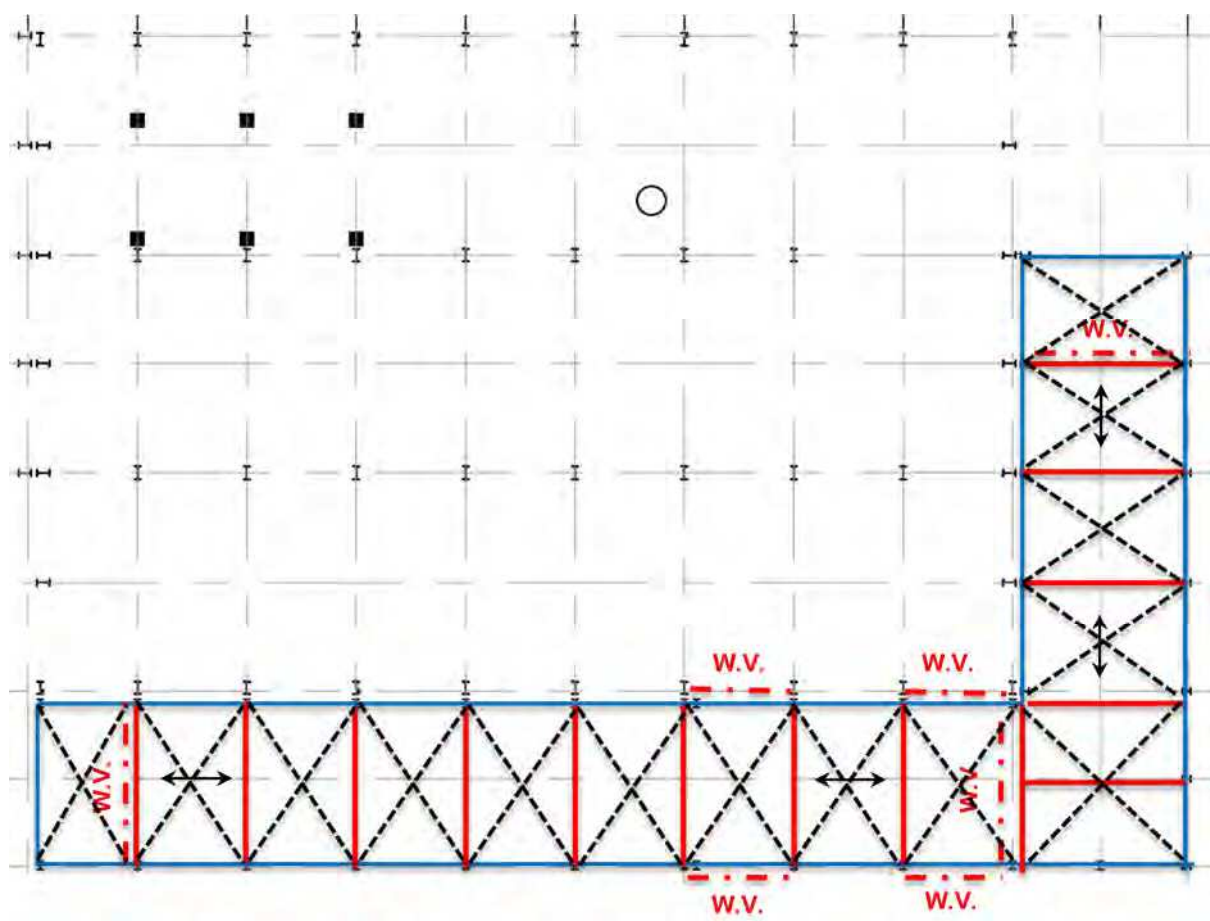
Schematisch overzicht dakconstructie, horizontale en verticale windverbanden
